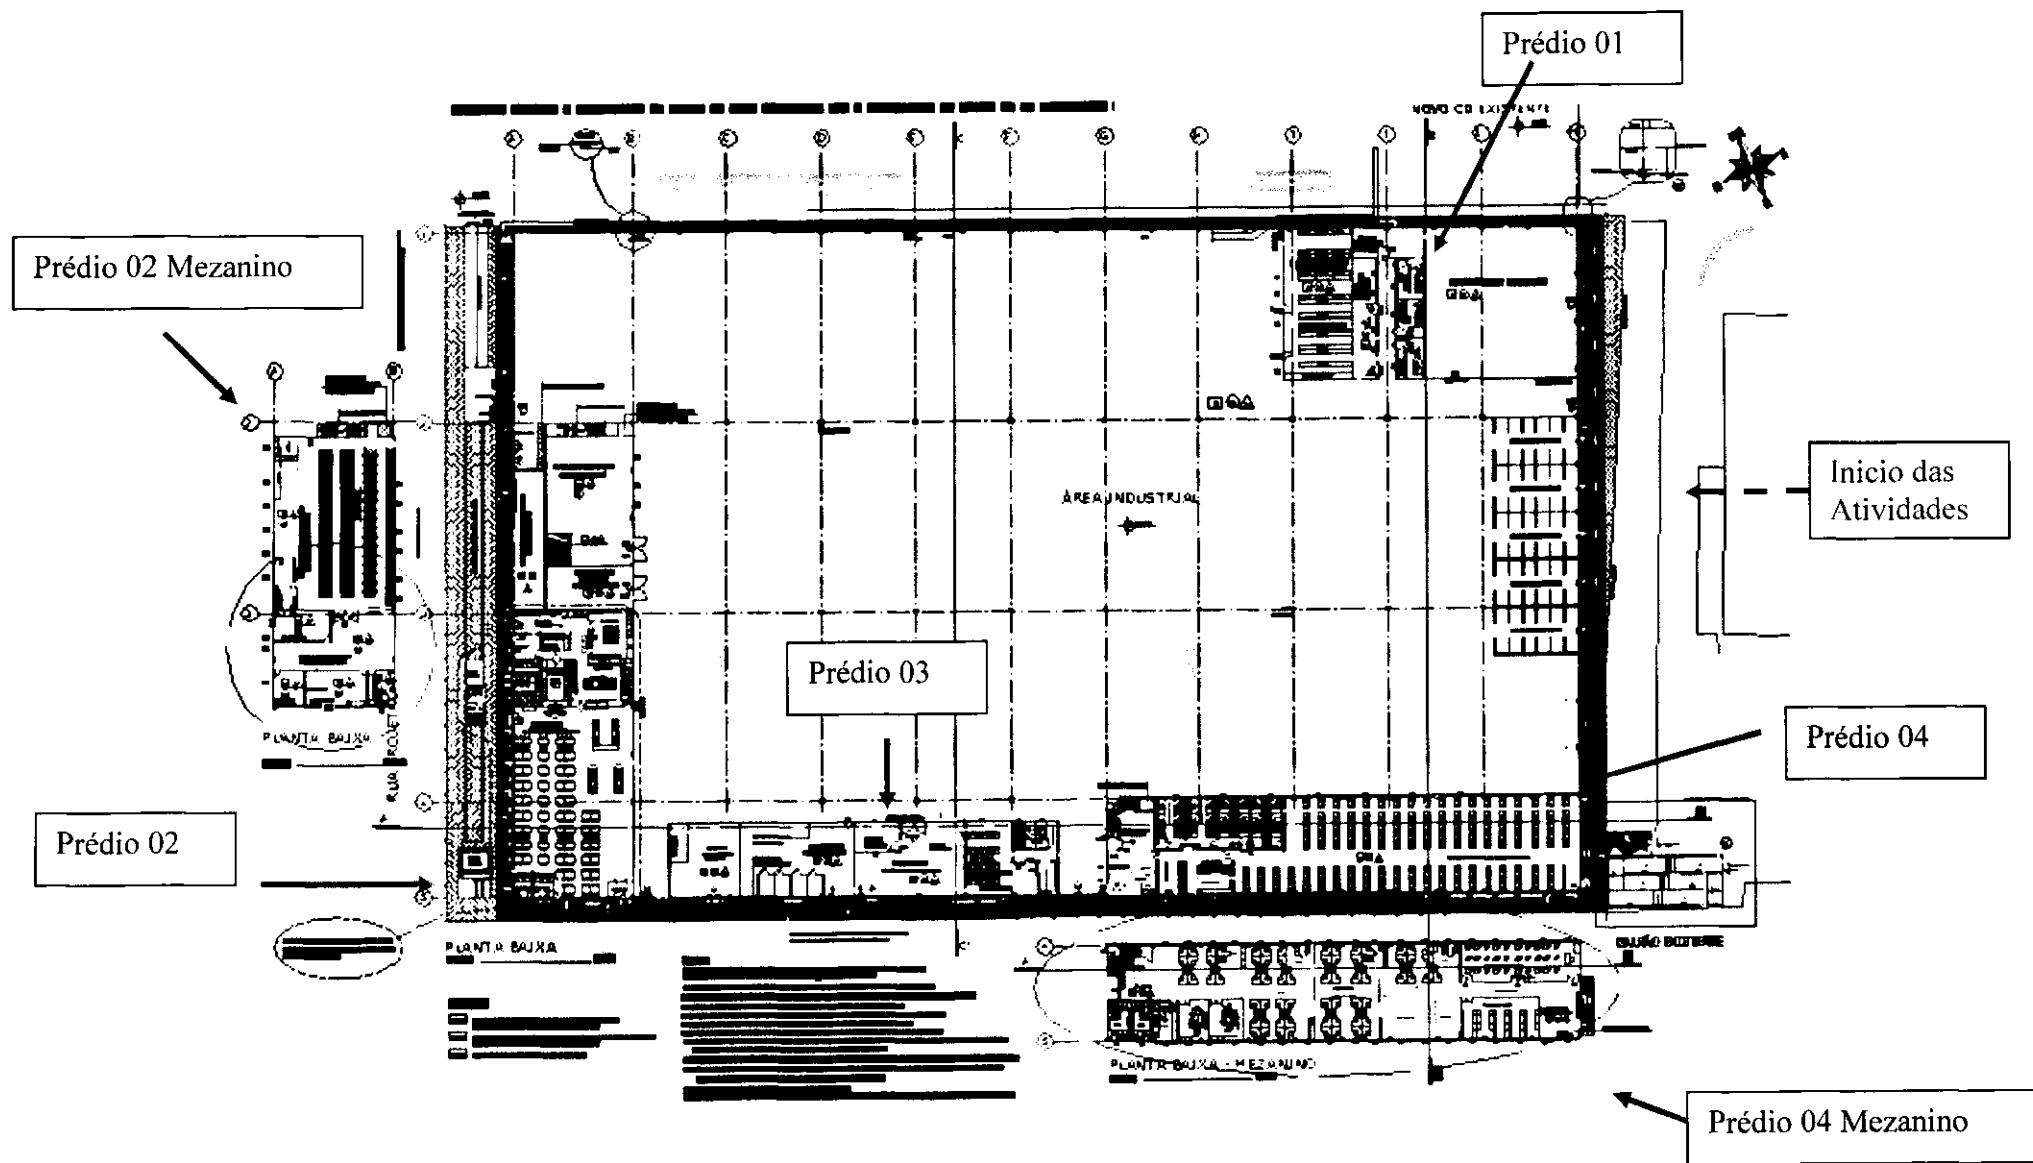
Planta Baixa da Construção da Ampliação da Alpargata
